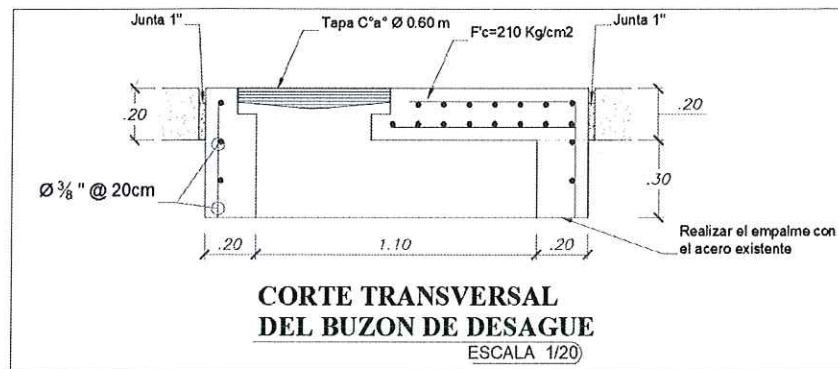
Estructuras proyectadas en la intervención. Fuente: Elaboración propia.
